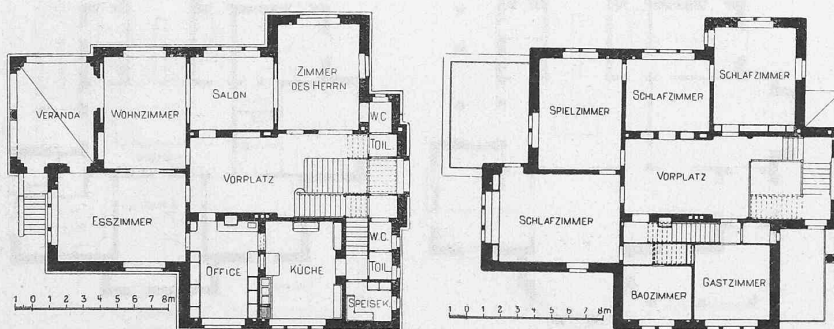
Grundrisse vom Erdgeschoss und I. Obergeschoss der Villa E. Huber-Stockar in Zürich V. — Masstab 1:400.
